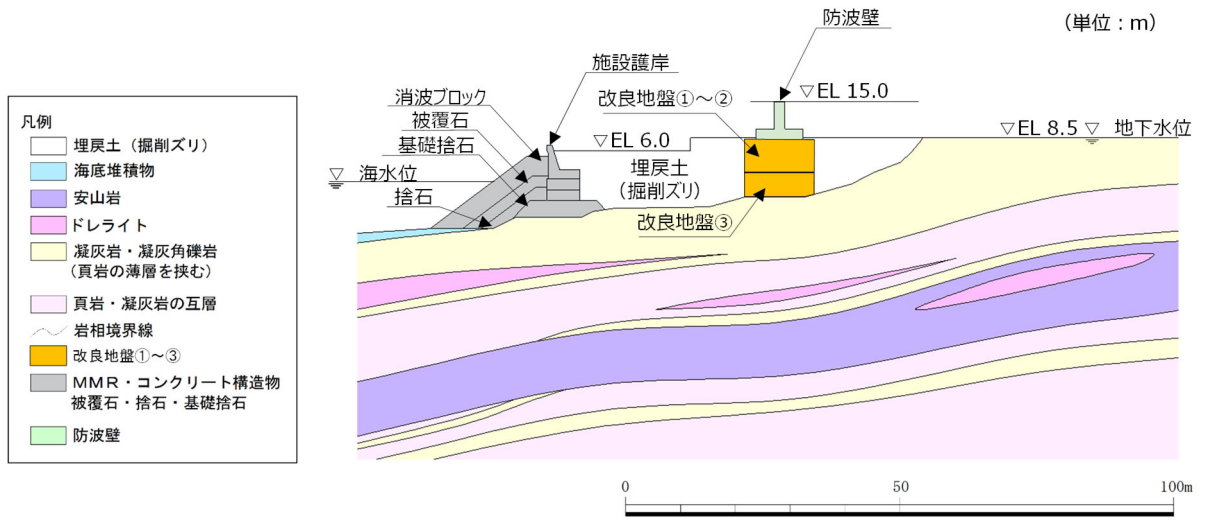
防波壁（逆 T 擁壁）の横断面図（①-①断面）
